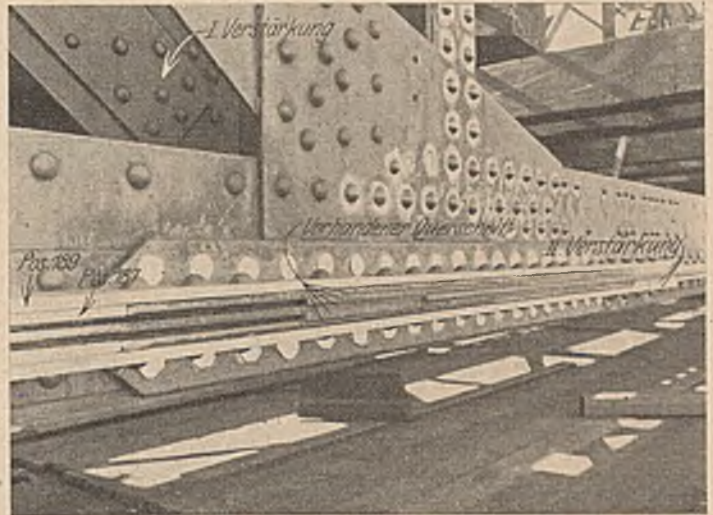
Kahnfahrtbrücke, Knotenpunkt 4.
